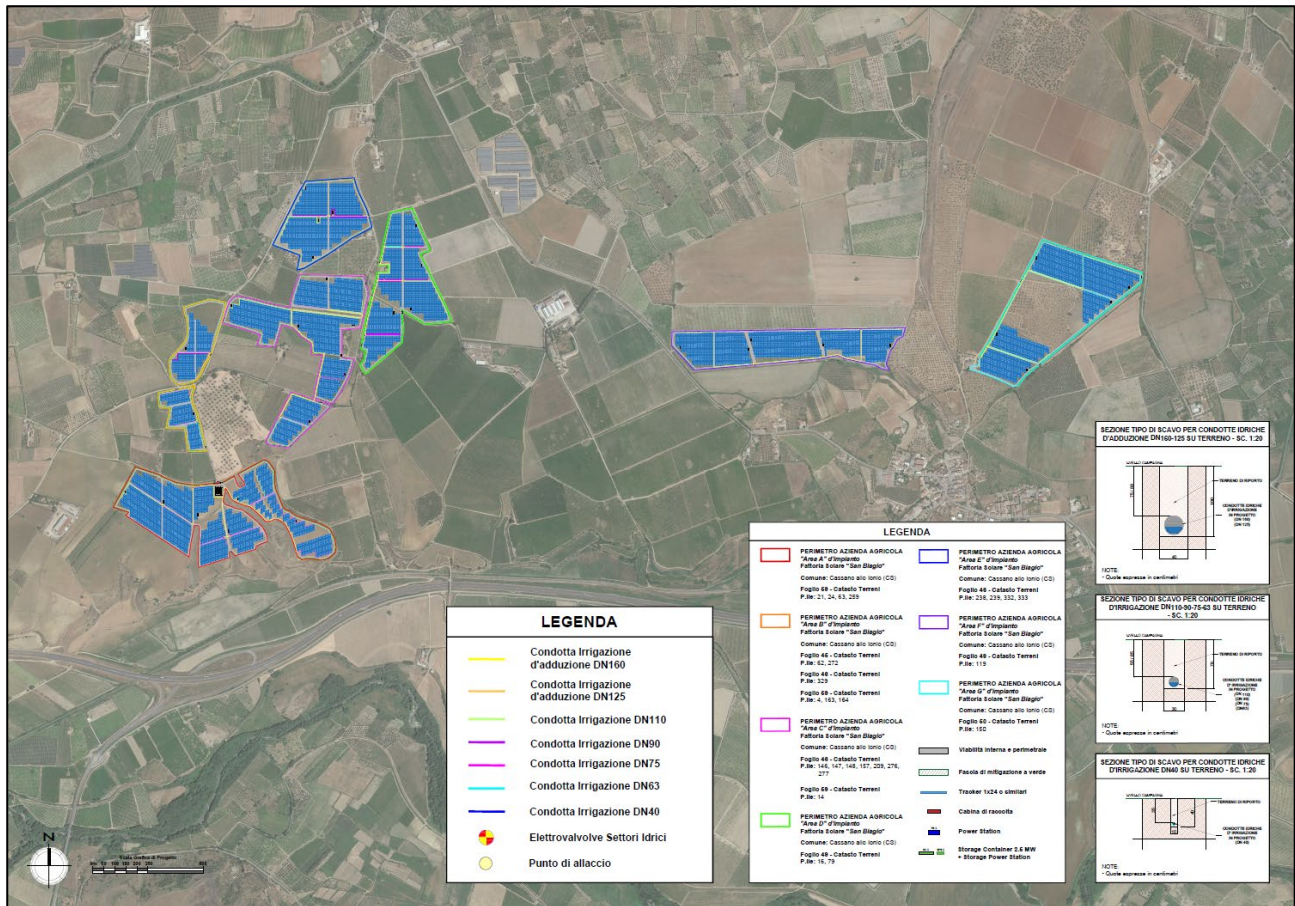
Layout Impianto di Irrigazione-Fertirrigazione
